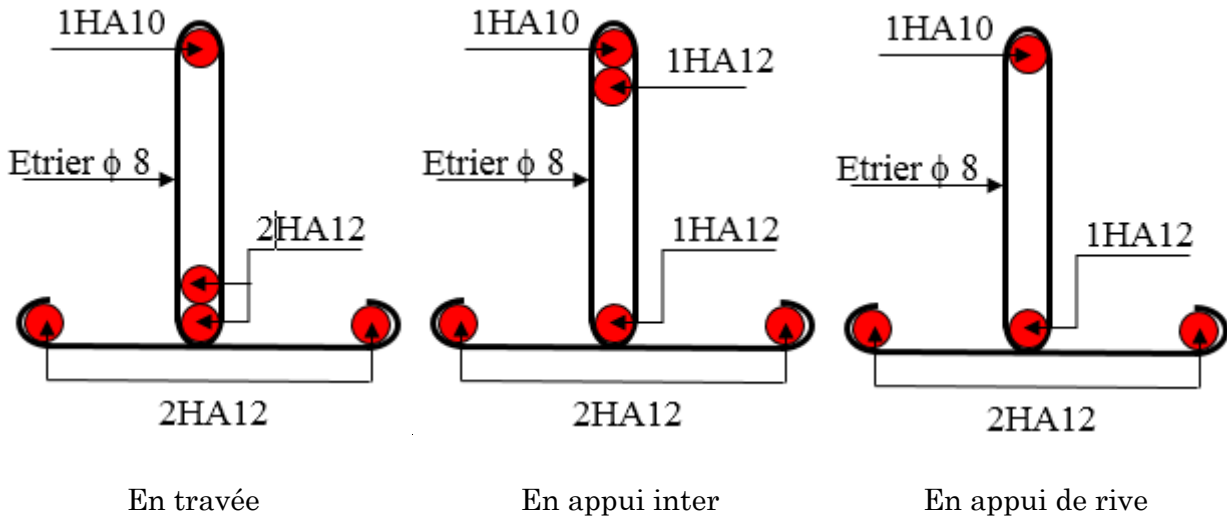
Schéma de ferrailage des poutrelles Plancher étage courant+RDC.
